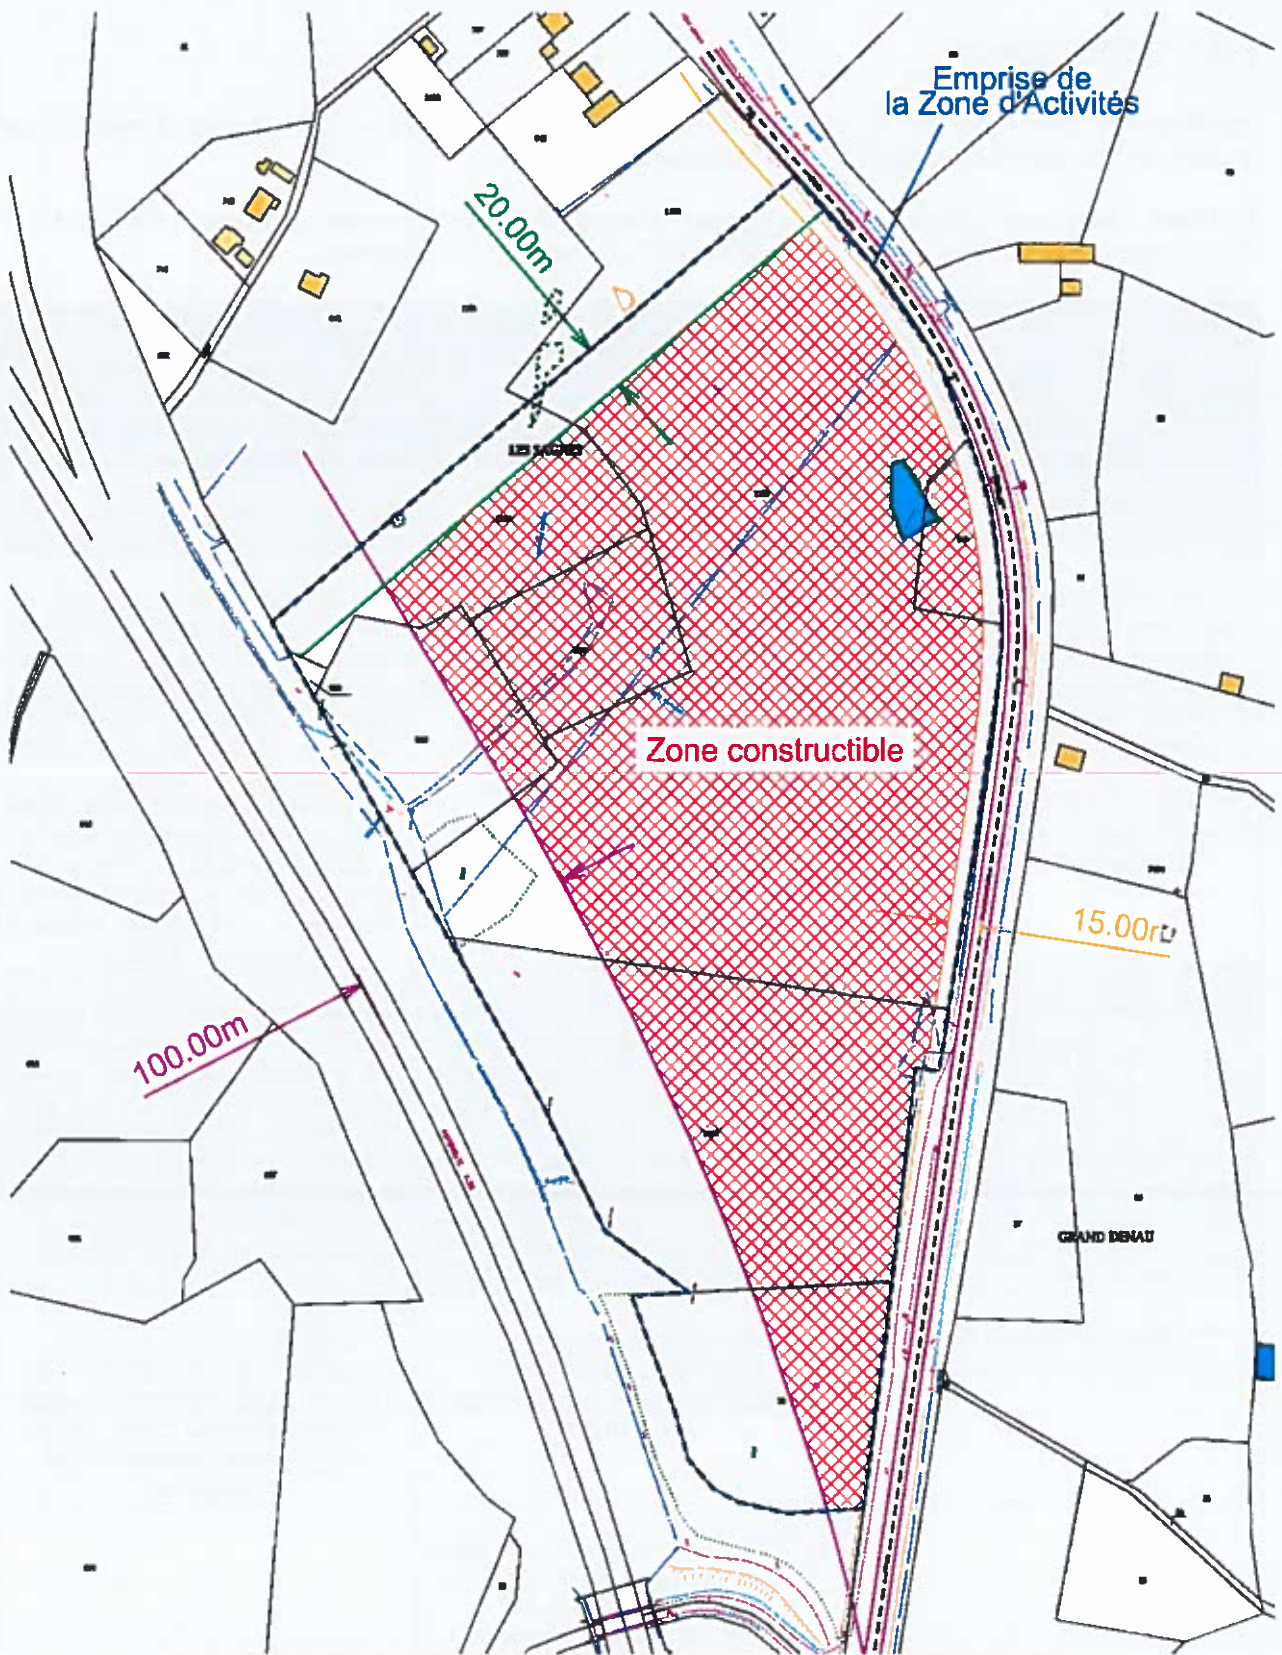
Délimitation des zones constructibles par rapport aux limites extérieures
